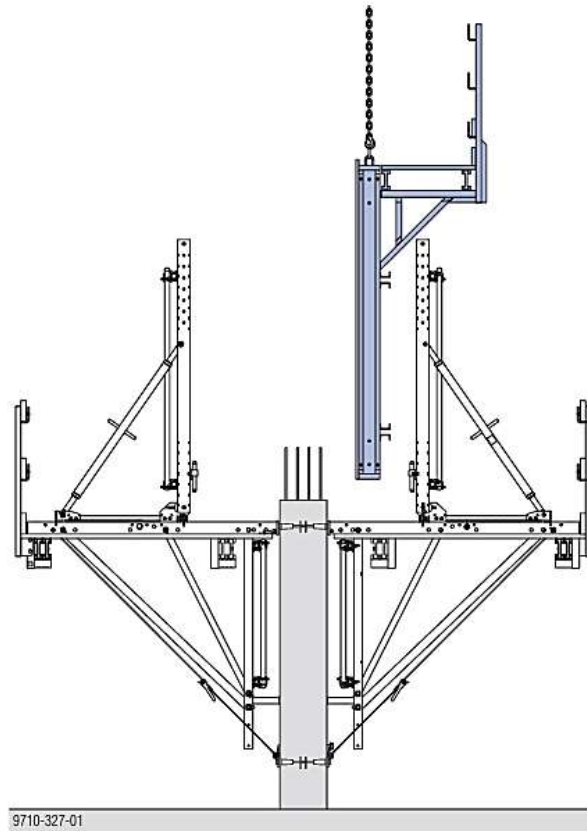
Montaje del sistema móvil para abrir y cerrar los paneles de la cimbra
